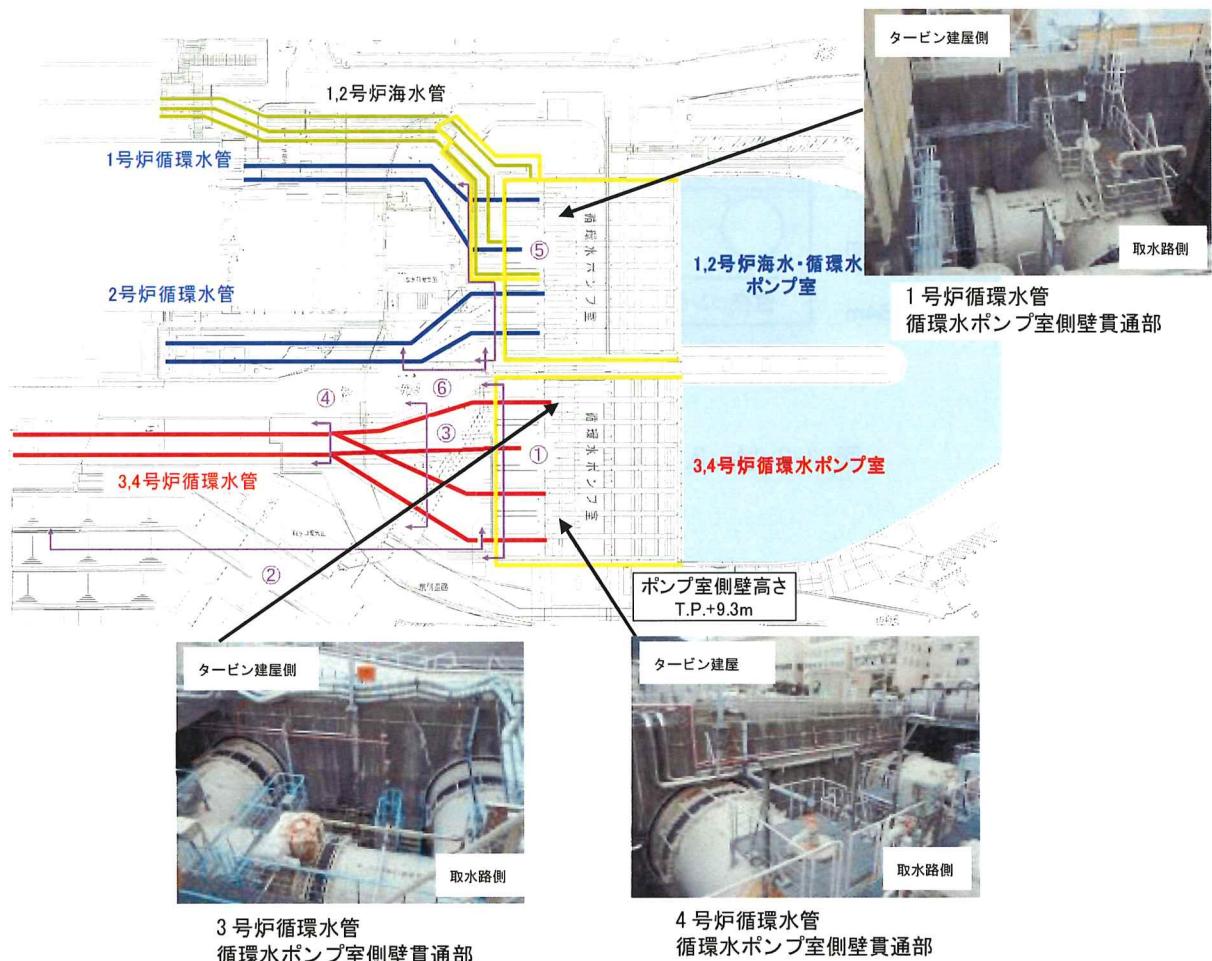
3, 4号炉循環水ポンプ室他 配置図
